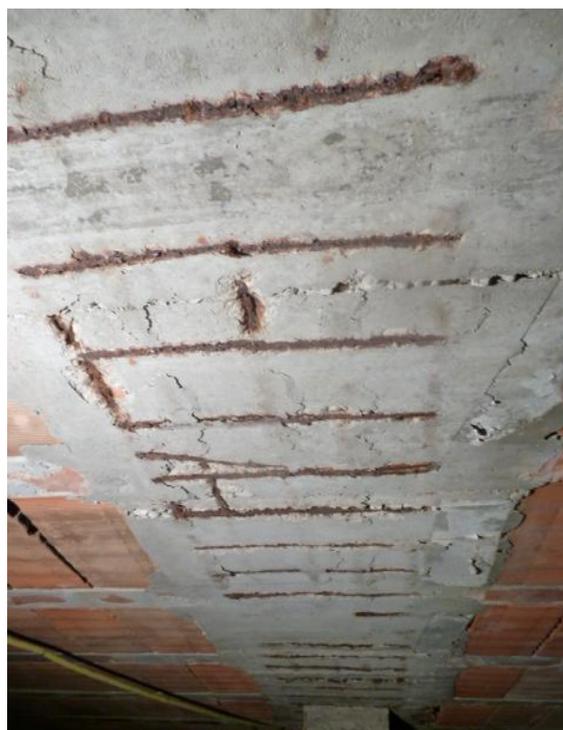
Oxidación/Corrosión del armado inferior de viga de forjado. Deficiente recubrimiento del armado.
